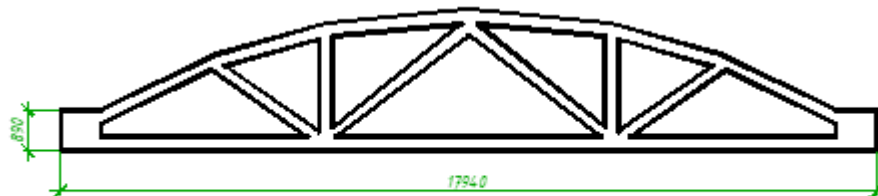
Збірні залізобетонні ферми за серією Р2834-690.82КЖИ
